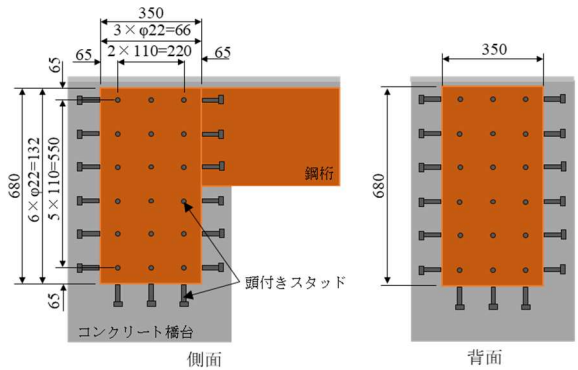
軸径 22mm を採用したスタッド配置の概要(寸法単位: mm)
